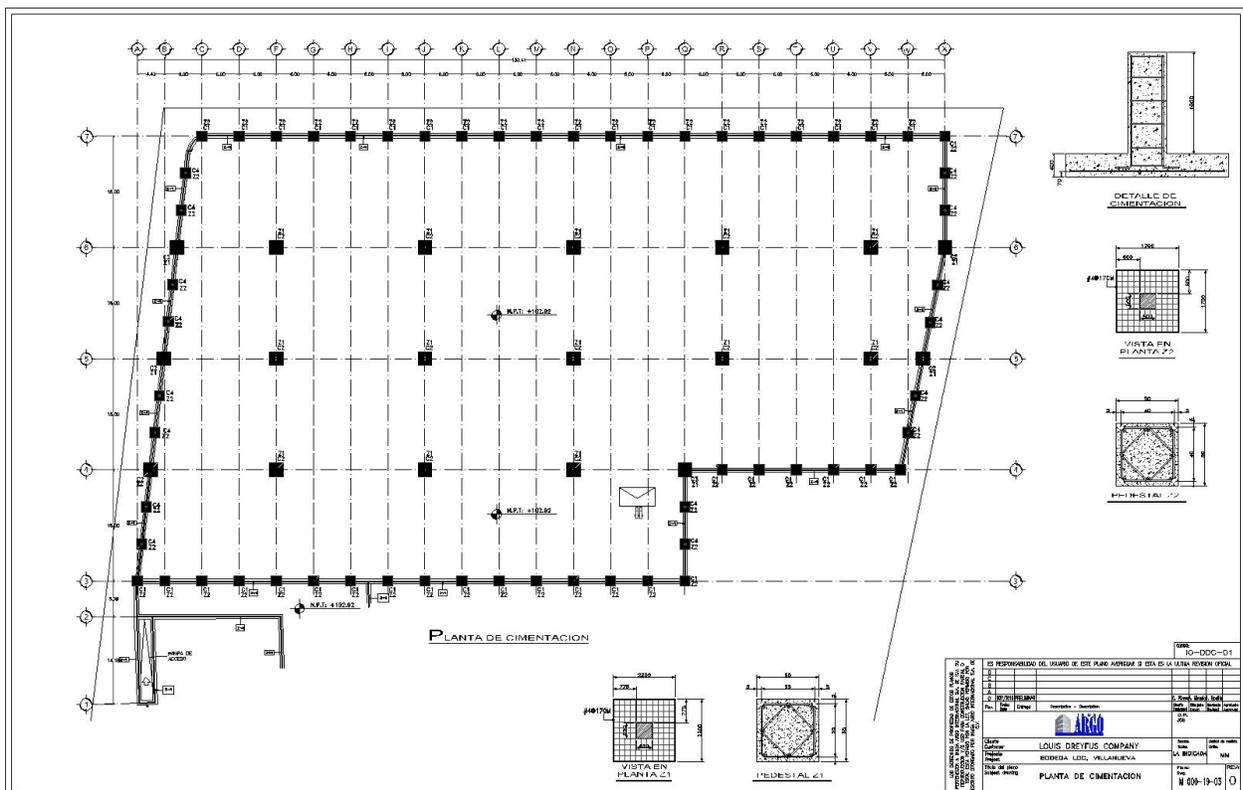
Propuesta para oferta de planta de cimentación para nave de almacenamiento
